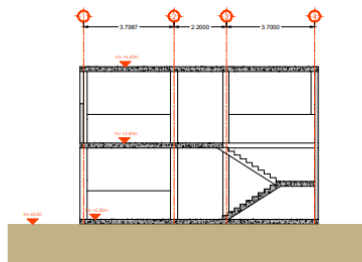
Plano Arquitectónico Área de Jaulas Caninas Bloque 2
